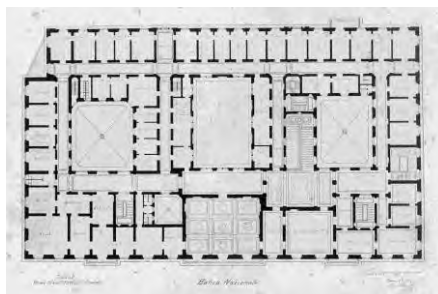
progetto Piacentini Banca d'Italia pianta piano primo
